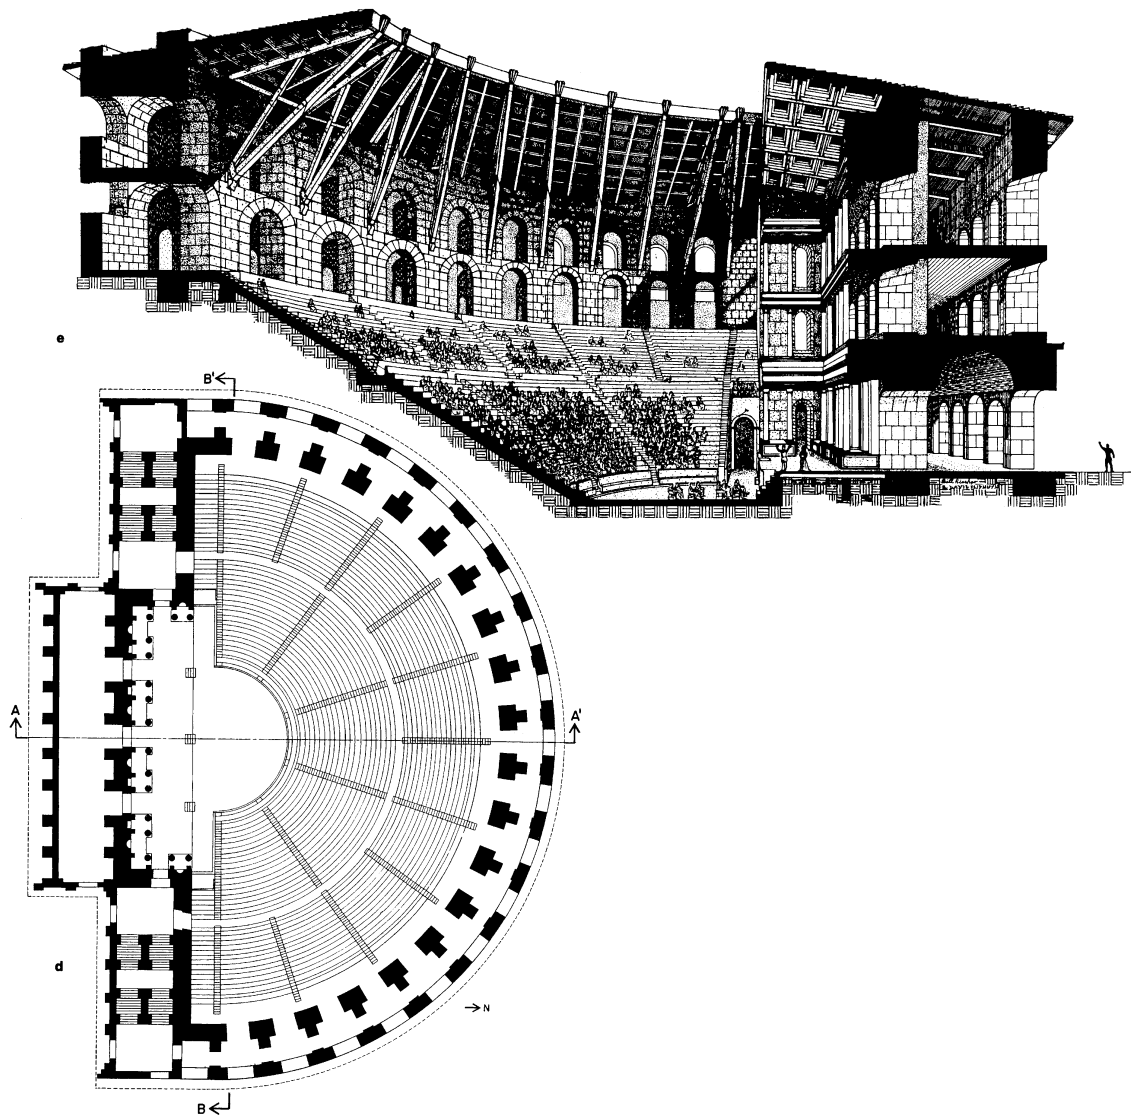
Odeion des Herodes Attikus. Grundriss und Rekonstruktion der Überdachung (Izenour 1992, Abb. 2,13)
